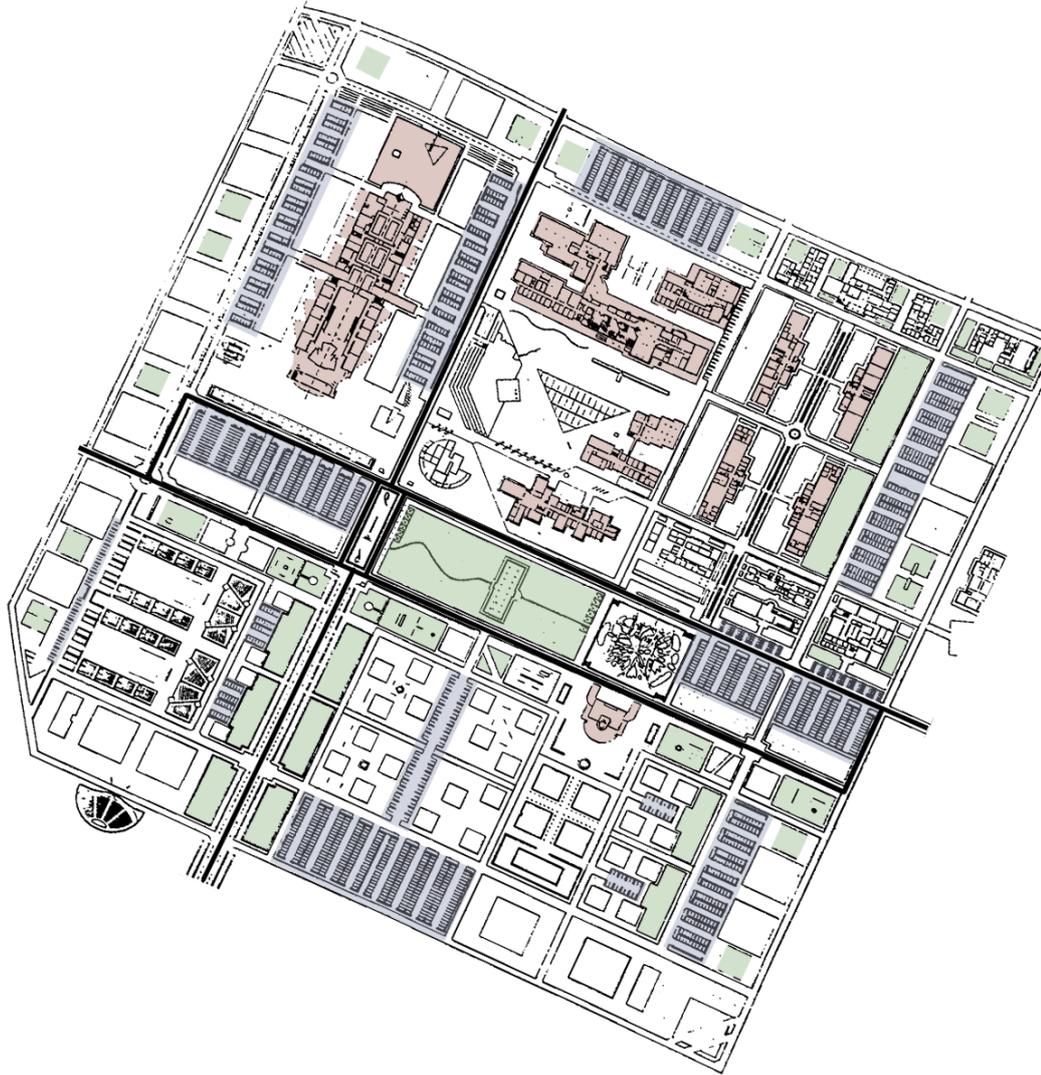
Planimetría Plan Especial del Campus de Alicante: E. Giménez.
